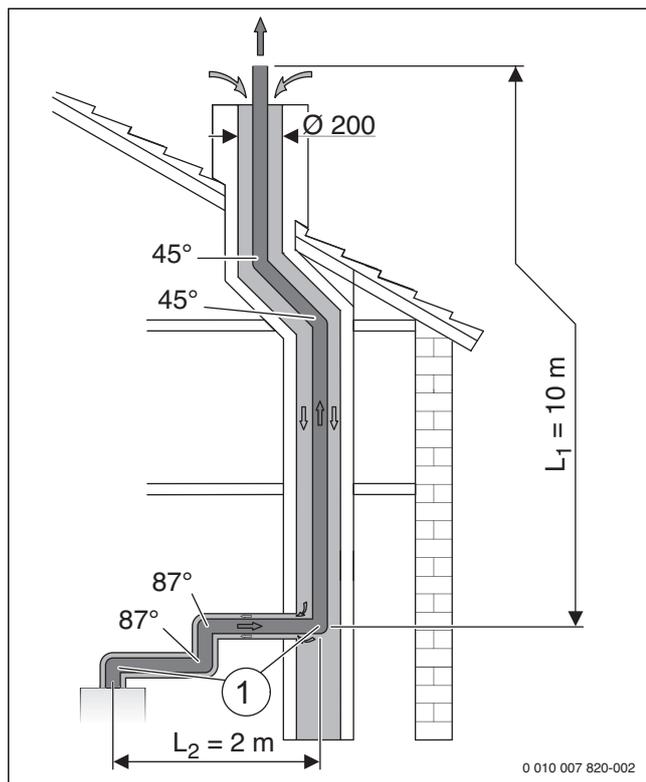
Einbausituation einer Abgasführung nach C_{93x}
